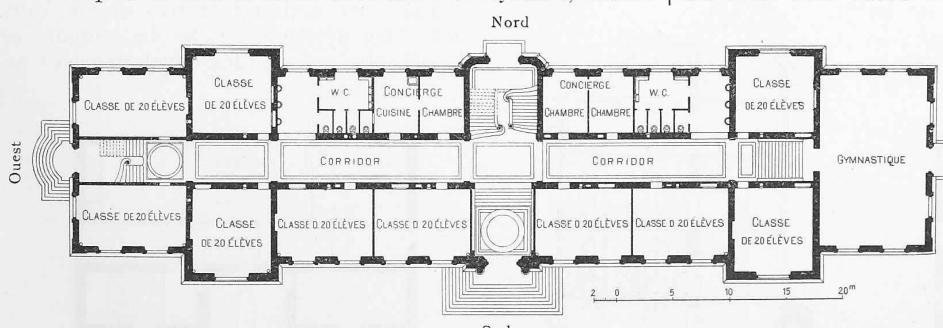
Ecole de commerce à Neuchâtel. — Plan du rez-de-chaussée. — Echelle 1:600.
